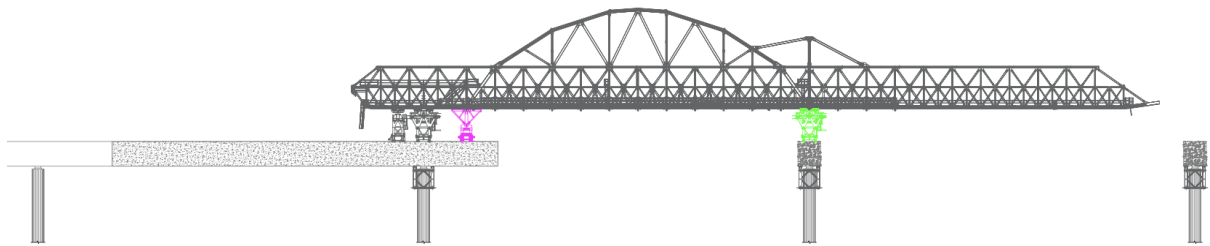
34 – Pórtico de betonagem (esquerda roxo) e pórtico do pilar (direita).
